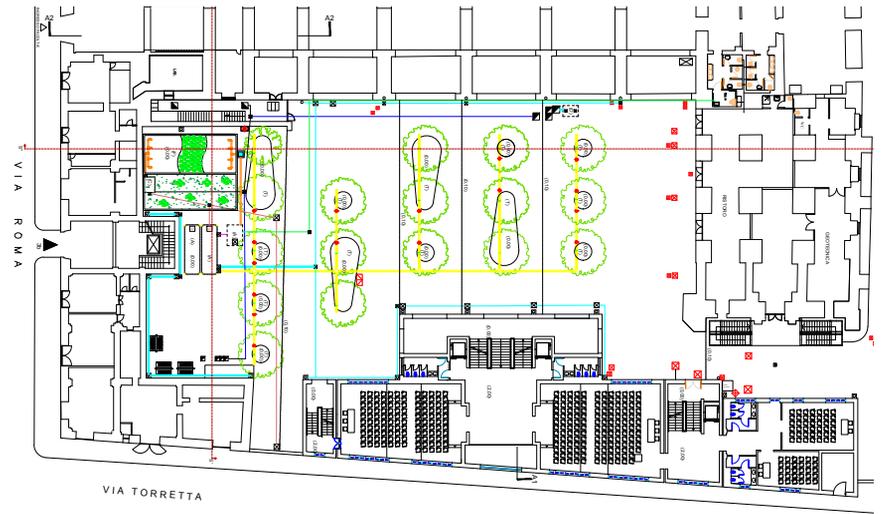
Planimetria del progetto idraulico di recupero delle acque meteoriche / *Plan of the hydraulic project for the rainwater harvesting* (Source: Authors' elaboration).
